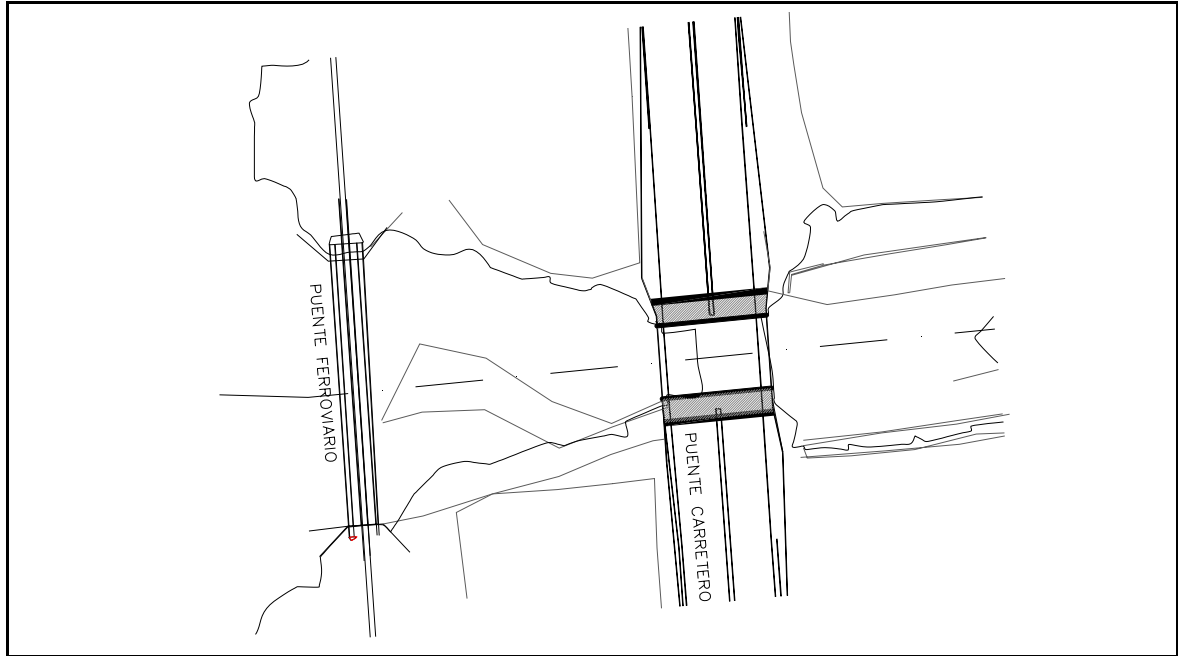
Plano en planta de ampliación del puente carretero , ancho 22 m
